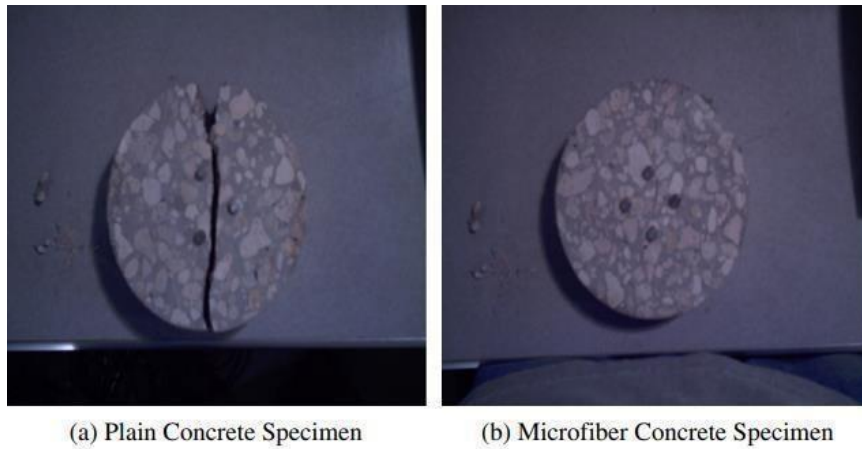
Fallo de probetas de hormigón bajo tensión. (a) Sin refuerzo. (b) Con refuerzo. Sameer Hamoush, Taher Abu-Lebdeh, Toney Cummins, 2010.
